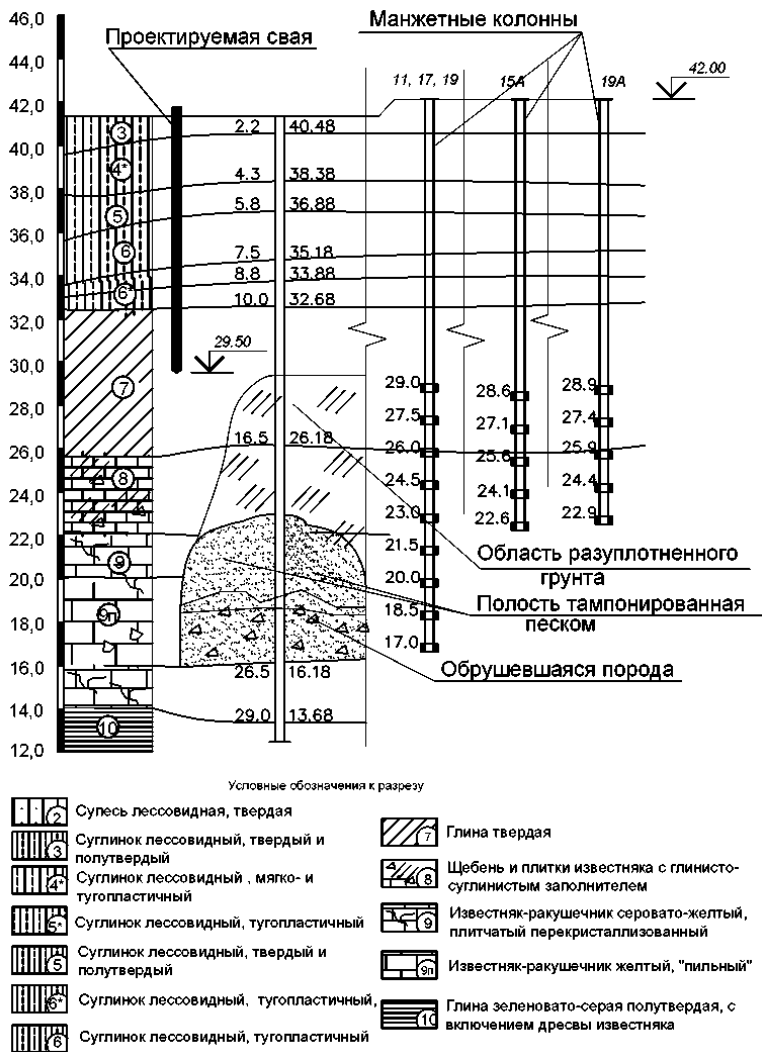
Расположения манжетных колонн на инженерно-геологическом разрезе в зоне обрушения кровли подземной выработки
